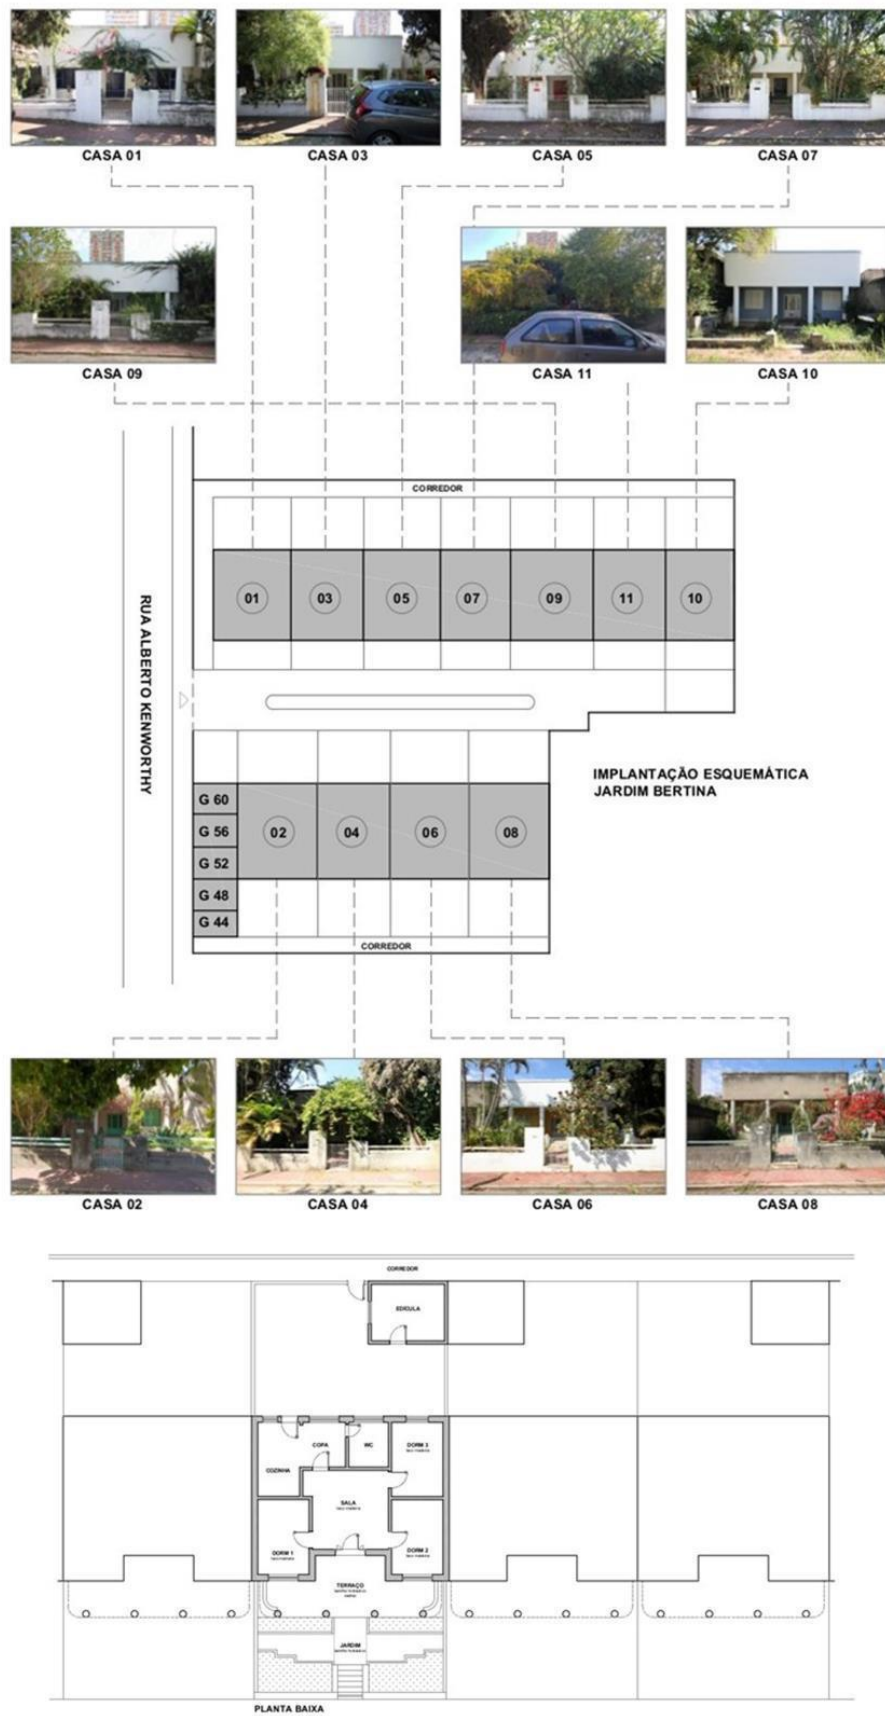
Implantação esquemática e Planta Baixa de uma das residências do “Jardim Bertina”.
